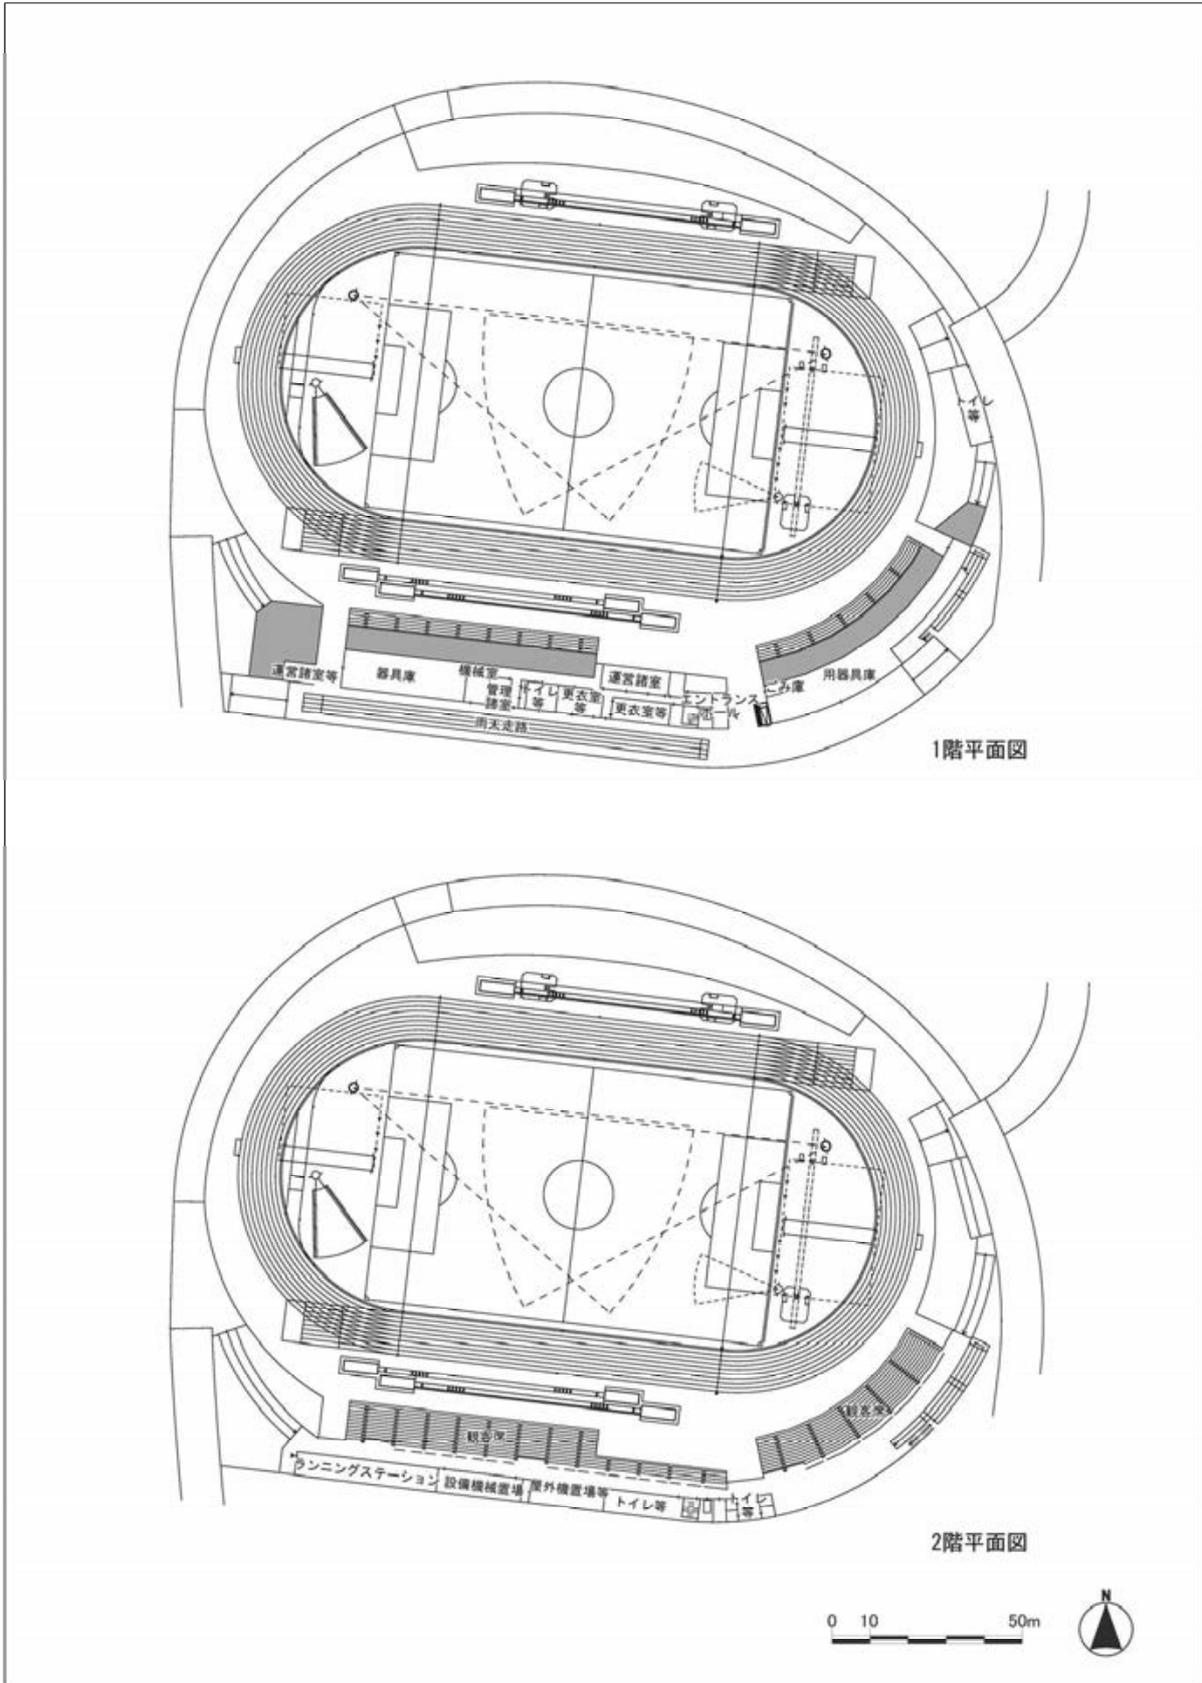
(14) (新) 等々力陸上競技場平面図 (1F,2F 平面図)
